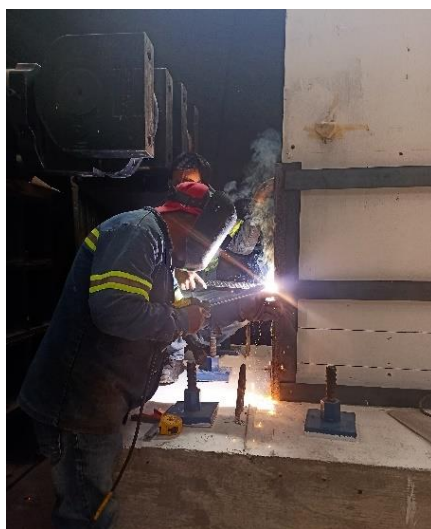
Soldadura del encamisado que lleva grout como medio de contacto.
